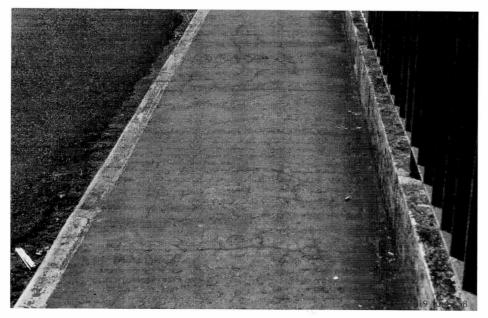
Detalhe das fissuras no passeio estão por toda a sua extensão.
